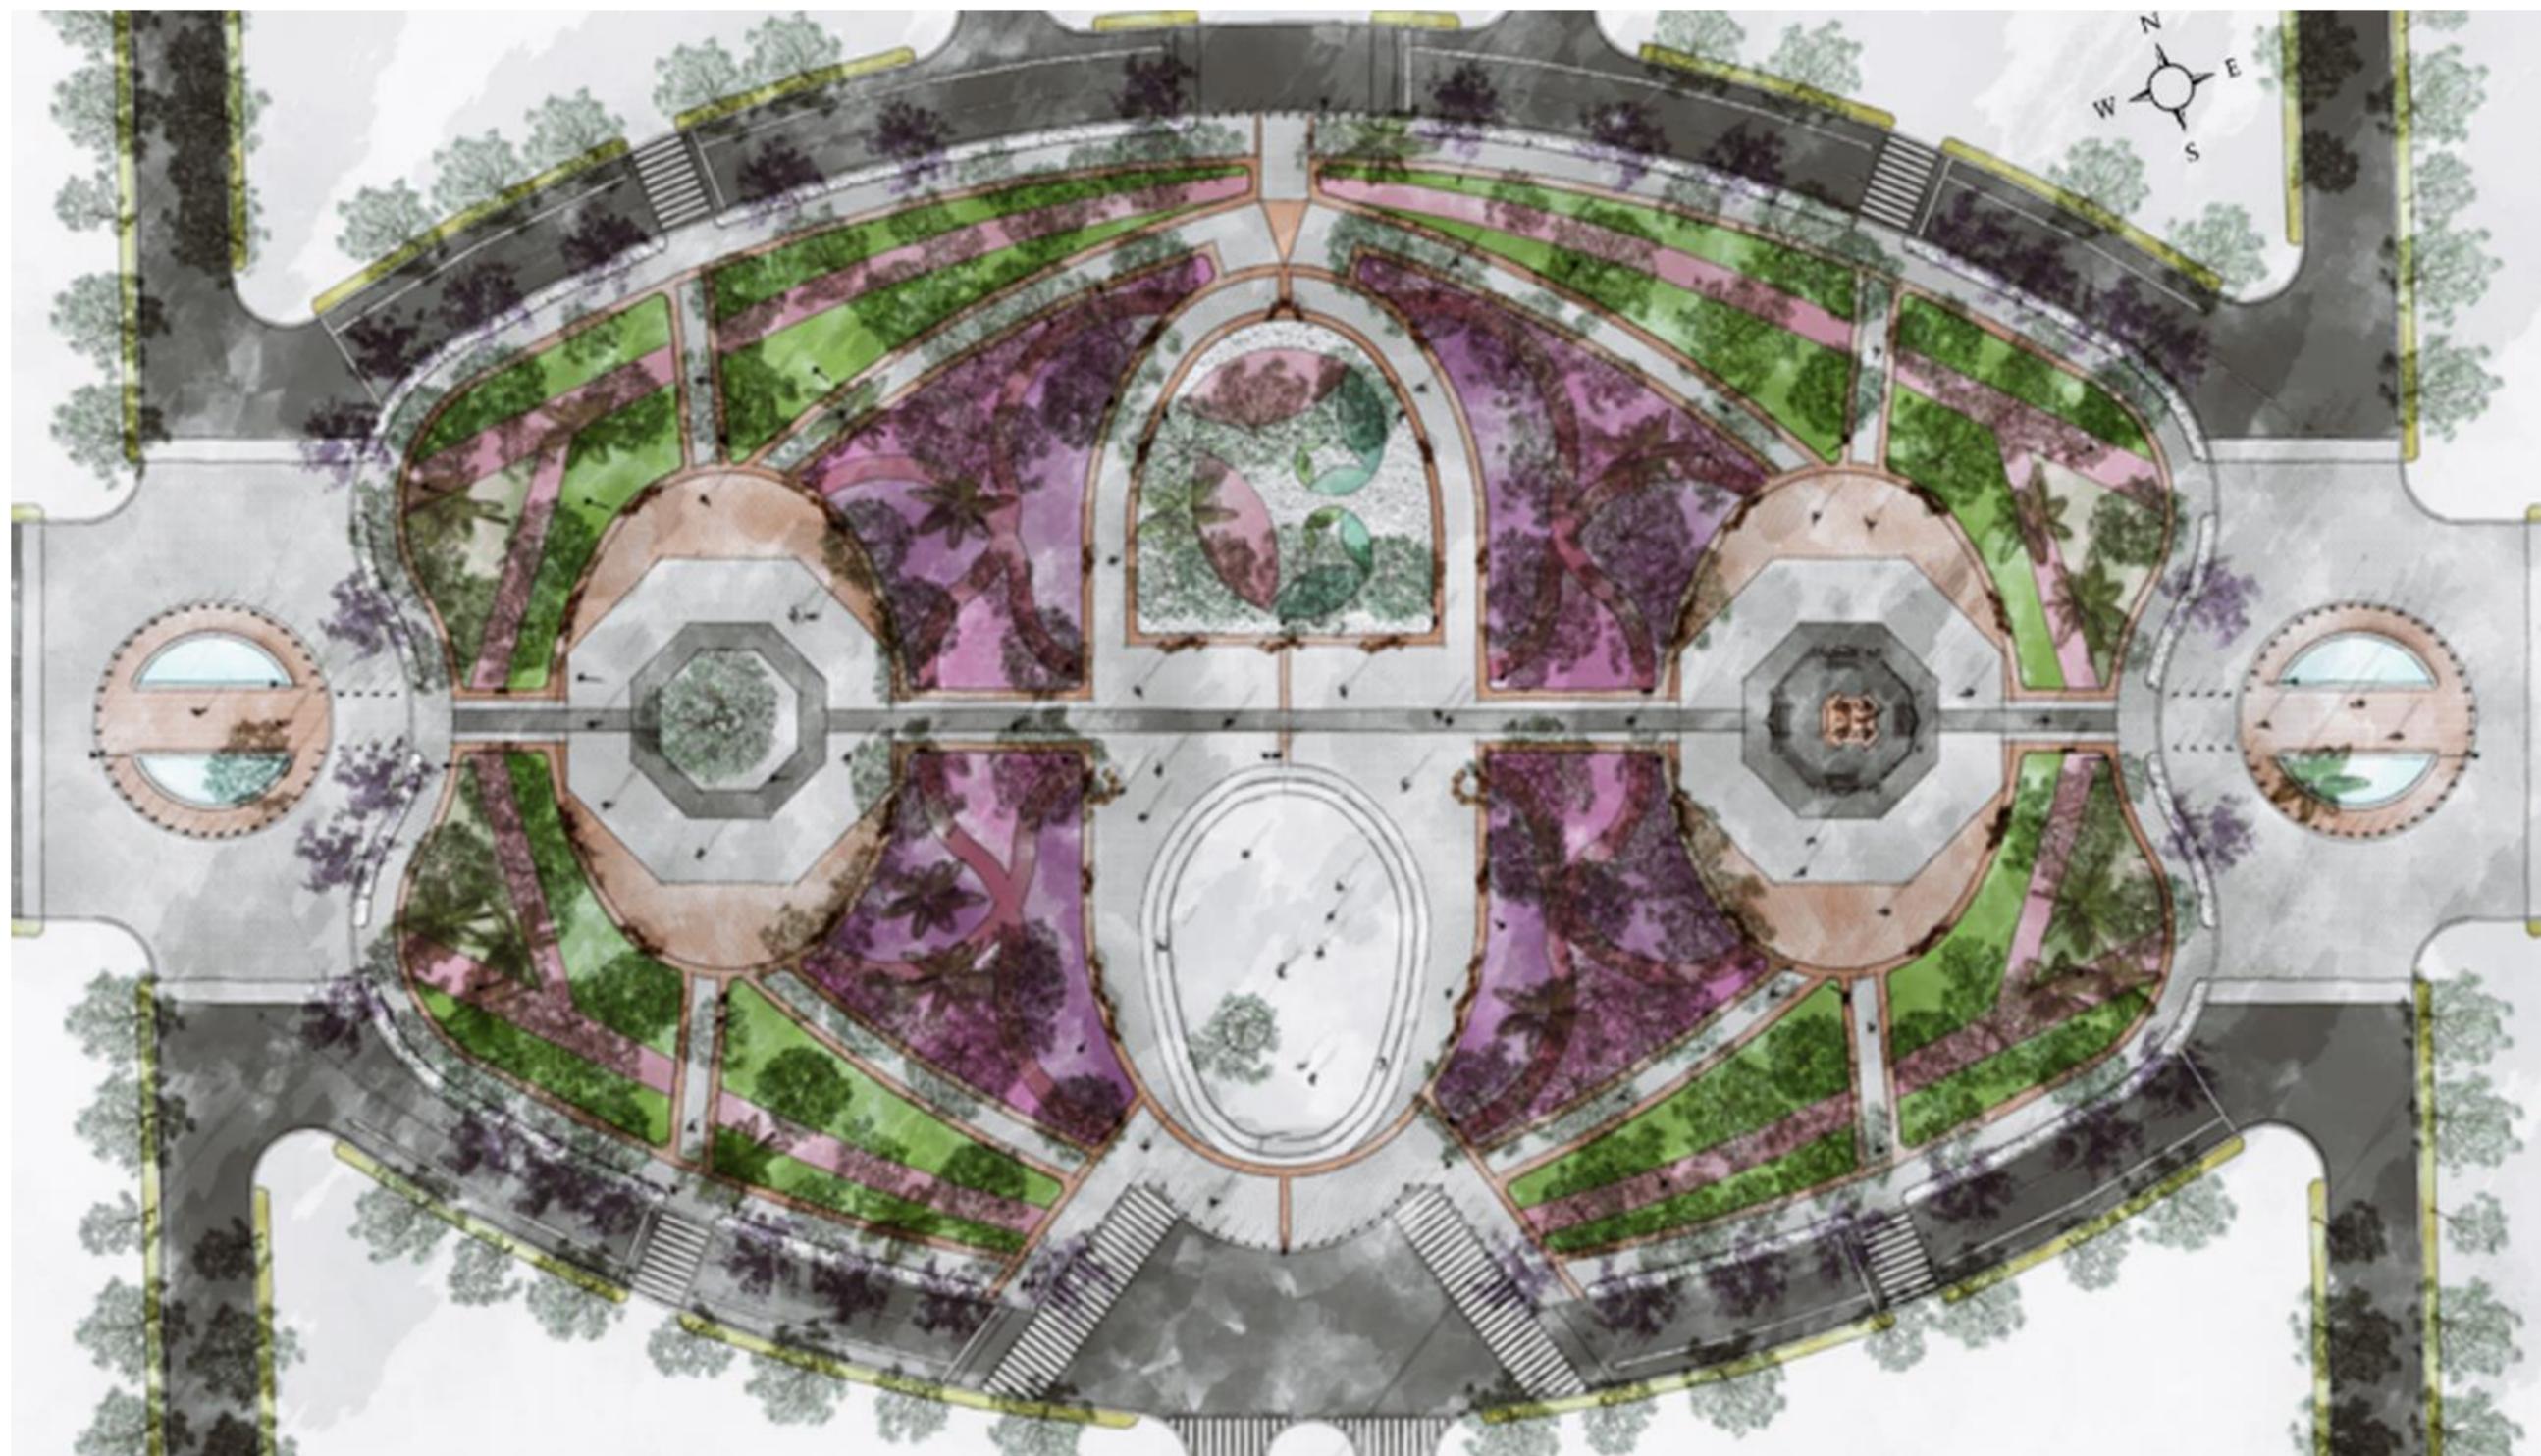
Planta de Conjunto, Proyecto de intervención Parque América. Elaboración propia 2021.
